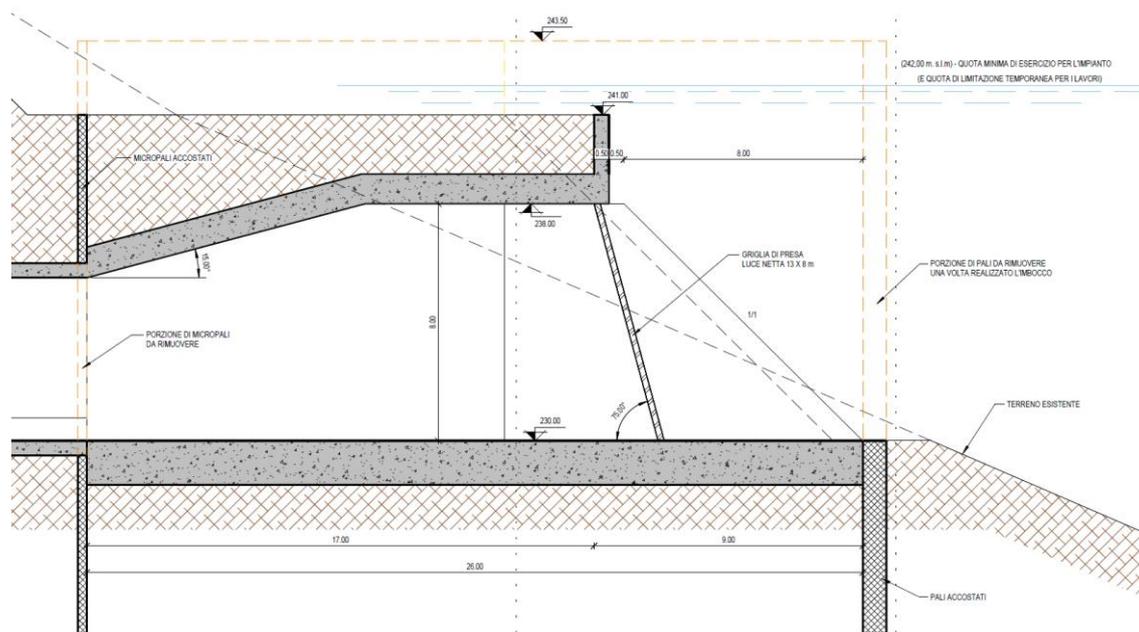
Sezione longitudinale dell'opera di presa di valle
